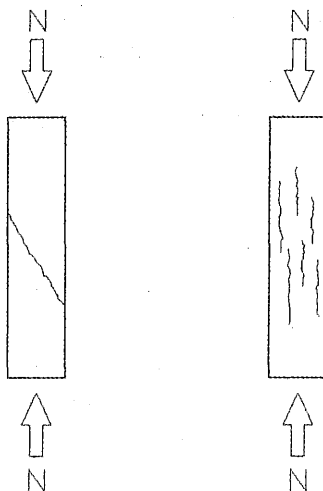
Fisuración por esfuerzo de compresión.
